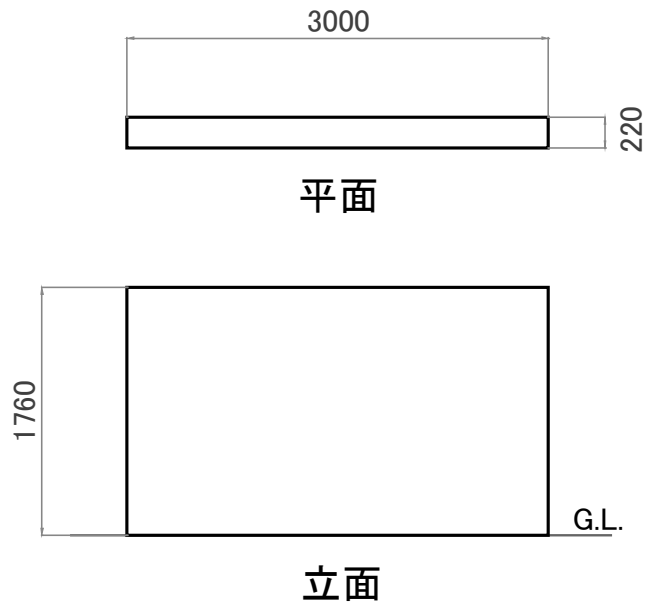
ST 冷蔵前の RC 塀 (東) 立面・平面図 (単位: mm)
